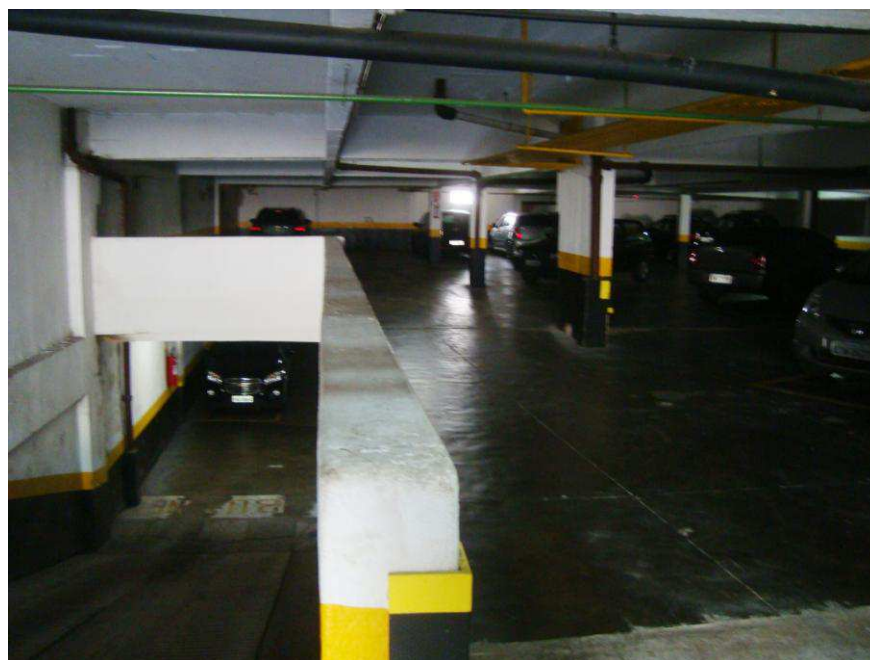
Vista parcial da rampa entre os pavimentos de estacionamento
